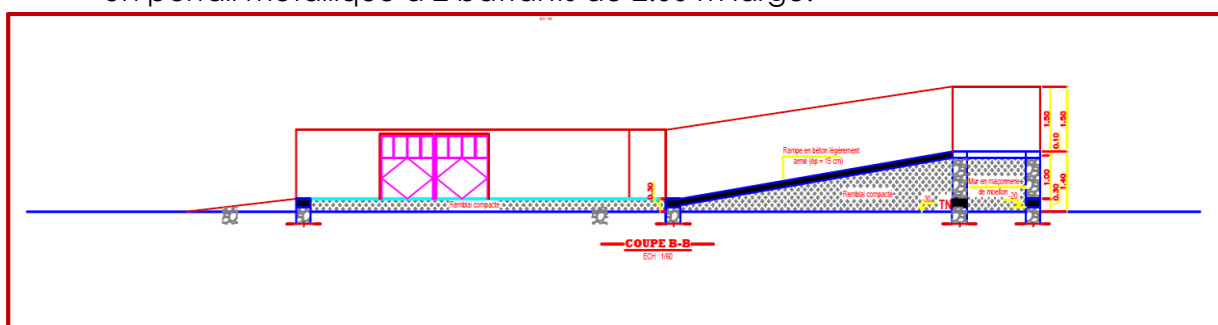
Parc d'attente, couloir de vaccination et rampe d'embarquement
